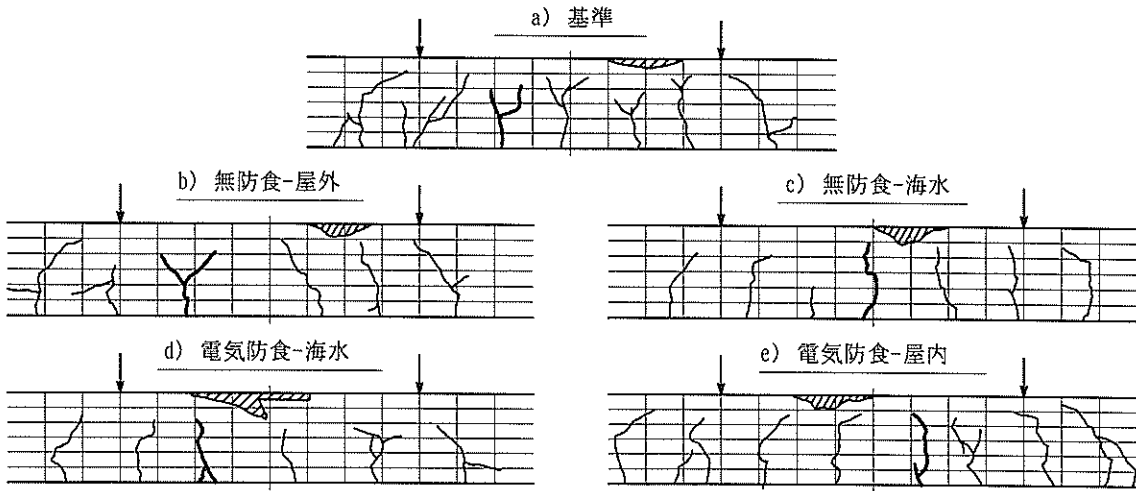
ひび割れ分散性状 (小型はり供試体)
